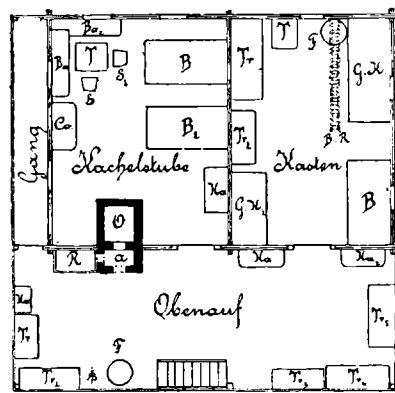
Grundriss des Obergeschosses des Gasperle-Hauses.
